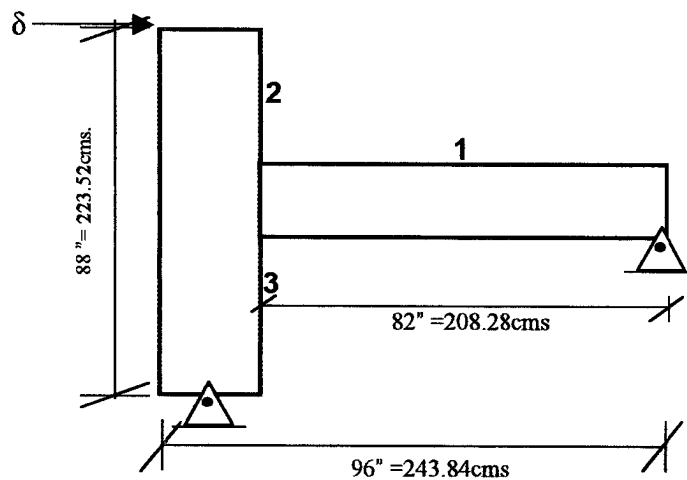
Dimensiones del espécimen viga plana – columna EWB2.ensayado por La Fave y Wight [14]
